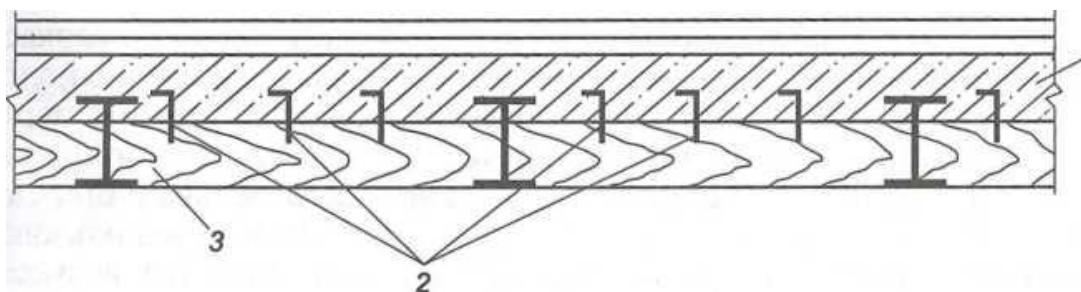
Монолитное железобетонное междуэтажное перекрытие с сохранением существующего междуэтажного перекрытия: 1 — монолитное железобетонное перекрытие; 2 — штыри-анкеры; 3 — существующее деревянное междуэтажное перекрытие
